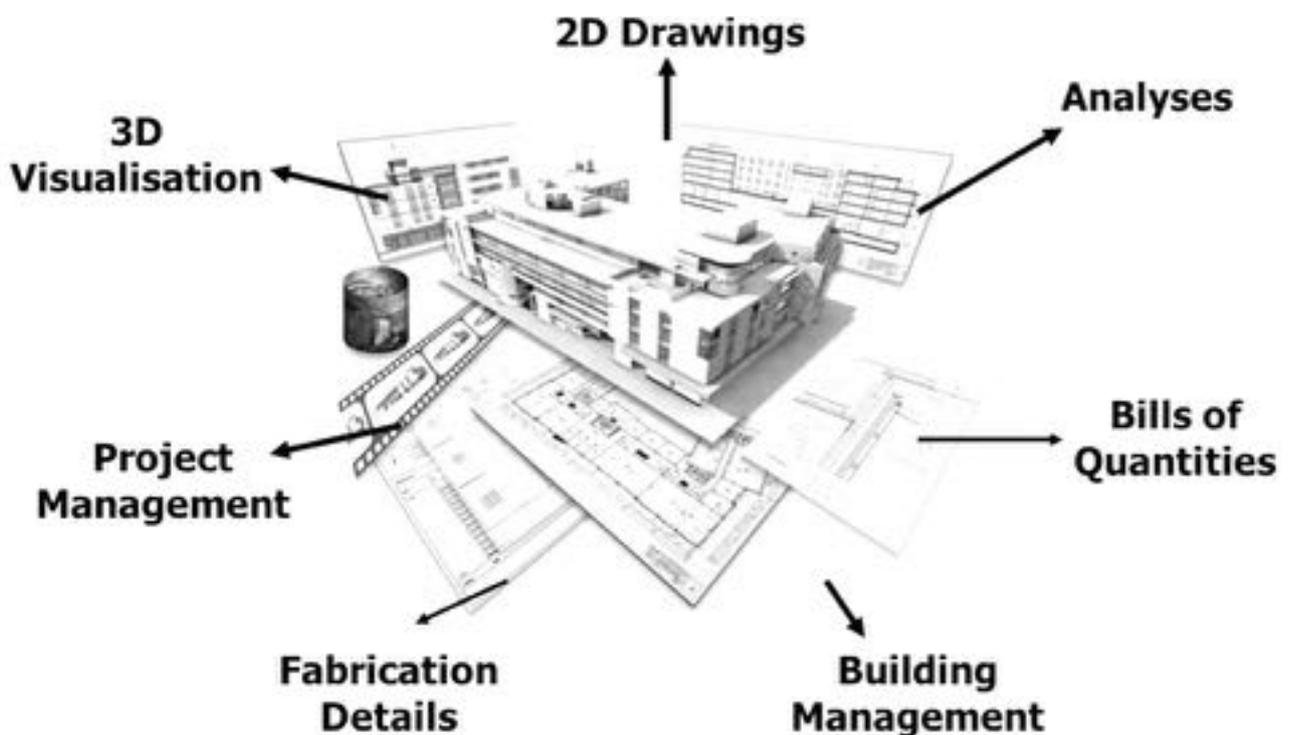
Facilidades que ofrece el sistema BIM para la construcción.
